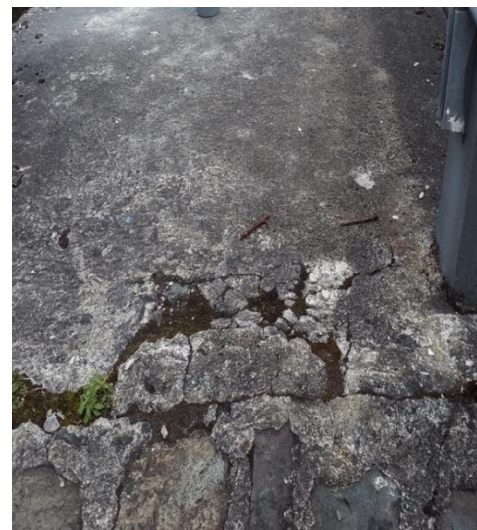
Fisuras en el pasamanería y material vegetal
